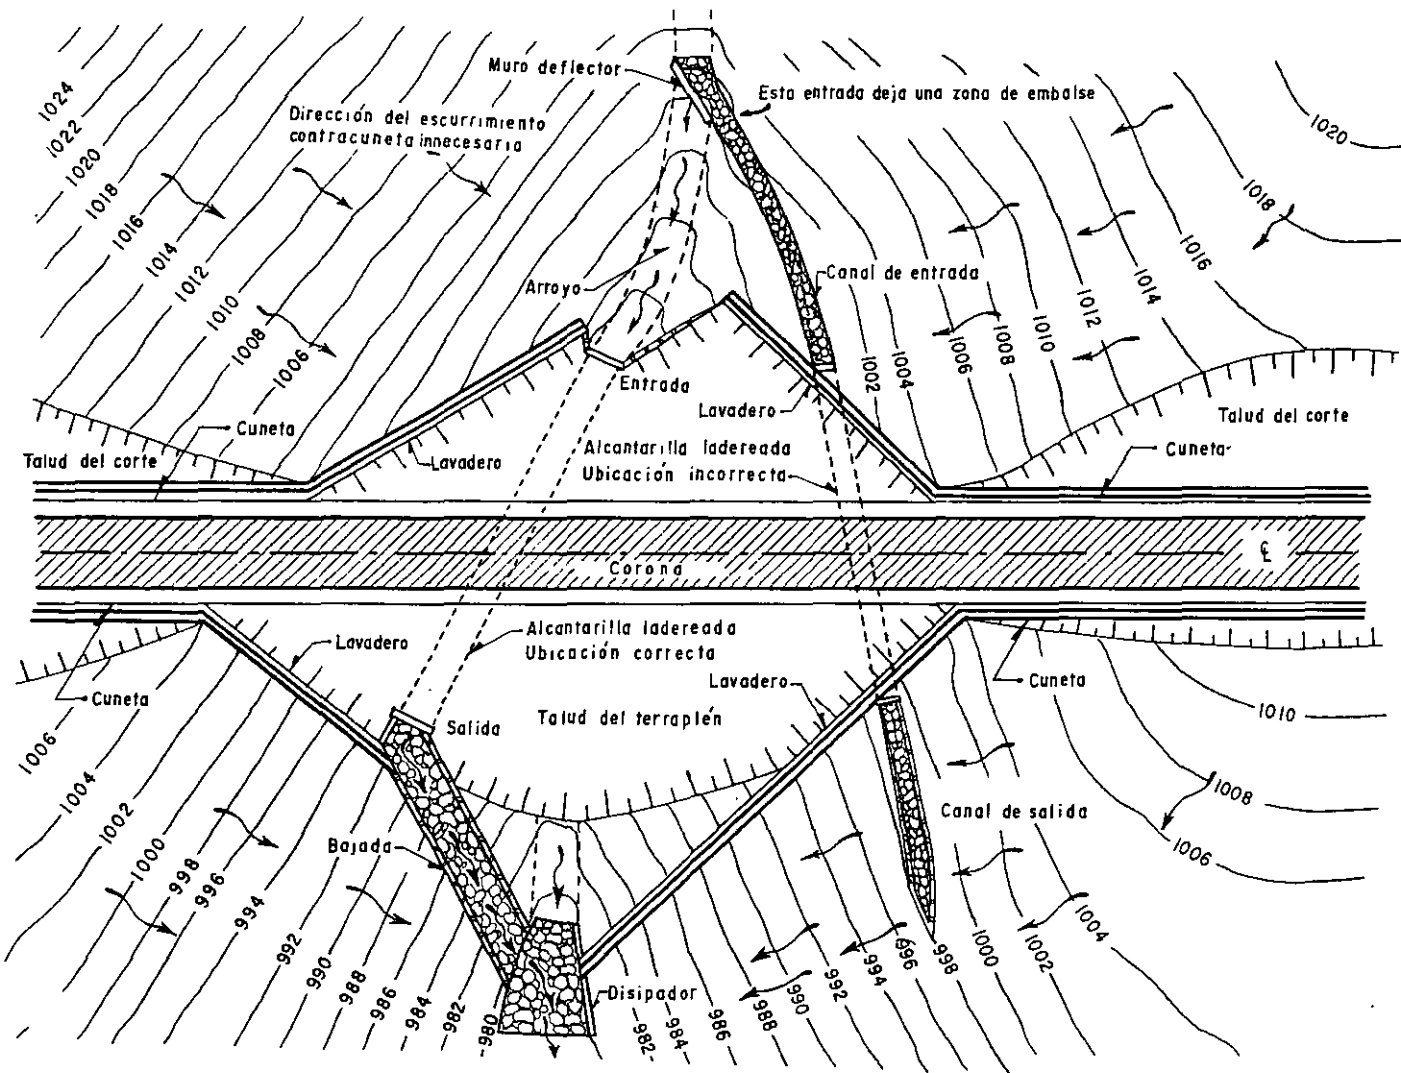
Ubicación de alcantarillas en laderas de cañadas.
